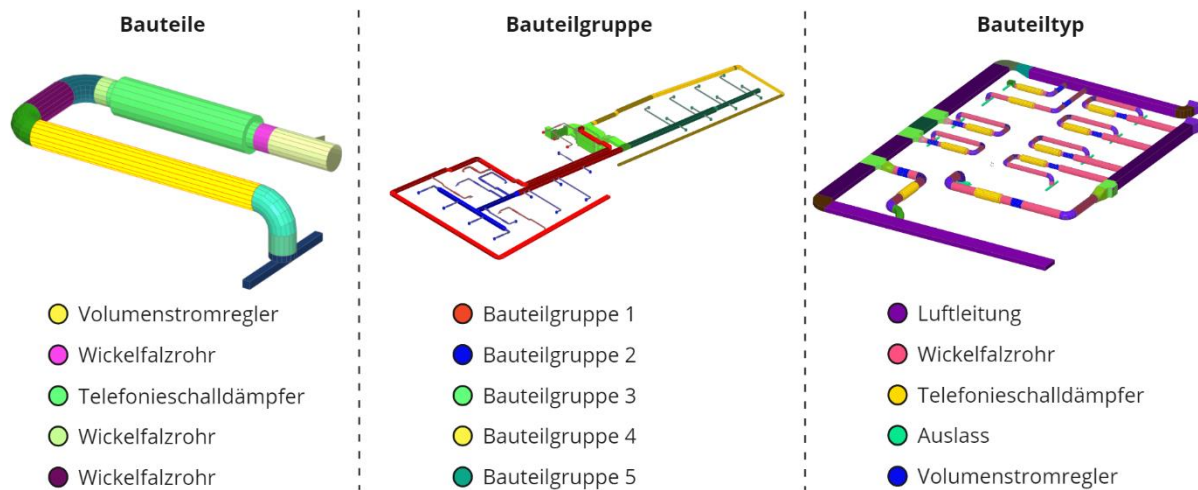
Unterscheidung Bauteile, Bauteilgruppe und Bauteiltyp (Eigene Darstellung, Desite / Miro, 2024)
